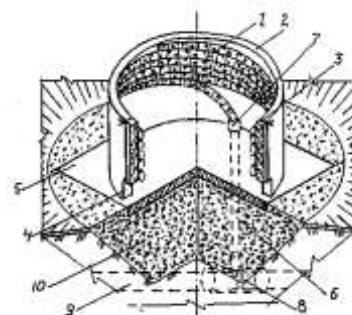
б. Конструкция колодца-поглотителя поверхностных вод с объемным водоприемным элементом [9]: 1 – фильтрующий водопоглощающий элемент; 2 – ограждающее железобетонное кольцо; 3 – бандаж; 4 – водопропускные отверстия; 5 – опорная плита; 6 – отводящий коллектор; 7 – соединительная муфта; 8 – тройник; 9 – отводящий коллектор высшего порядка; 10 – обсыпка из материала с высокой водопроницаемостью
